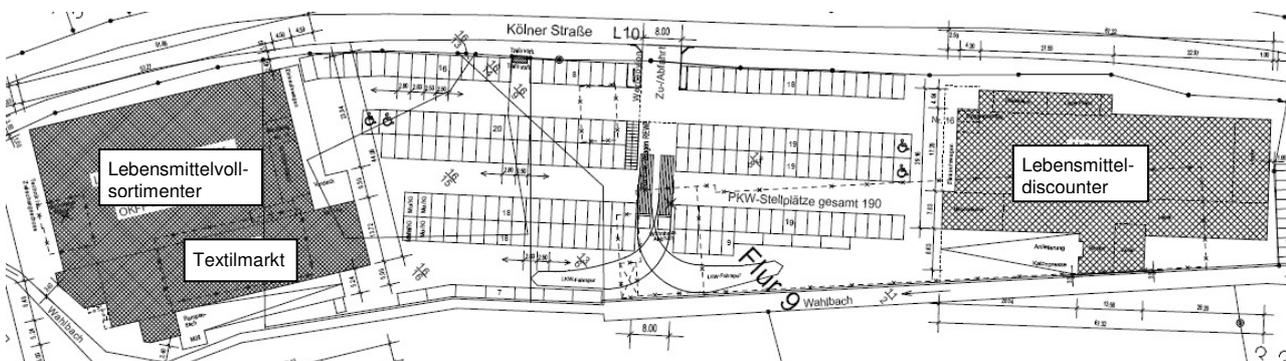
Freiflächenplan Einzelhandelsansiedlung (Ingenieurbüro Steinbrunn GmbH, Hillesheim, Stand: 29.09.2008)
